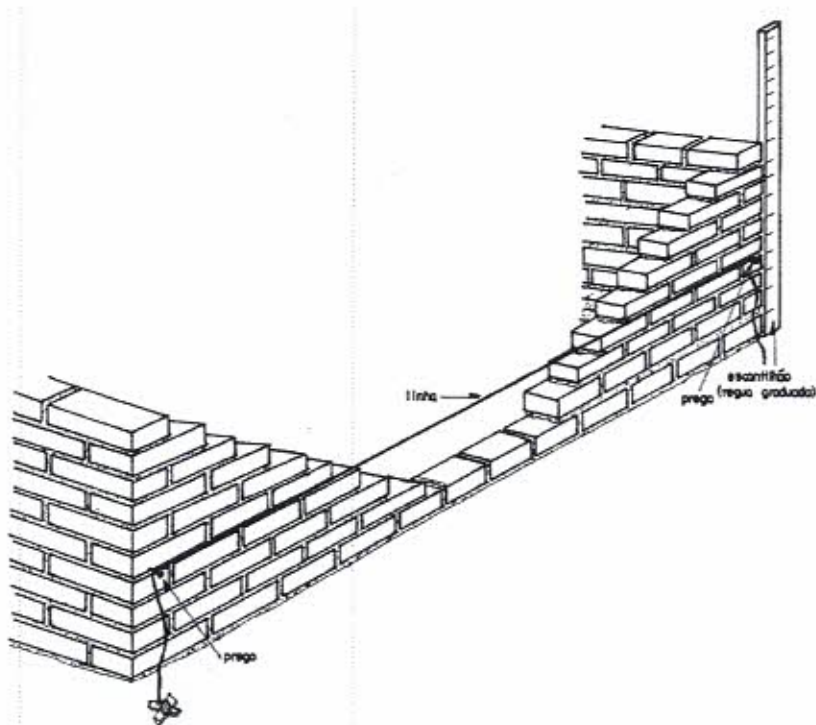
Detalhe do nivelamento da elevação da alvenaria.
